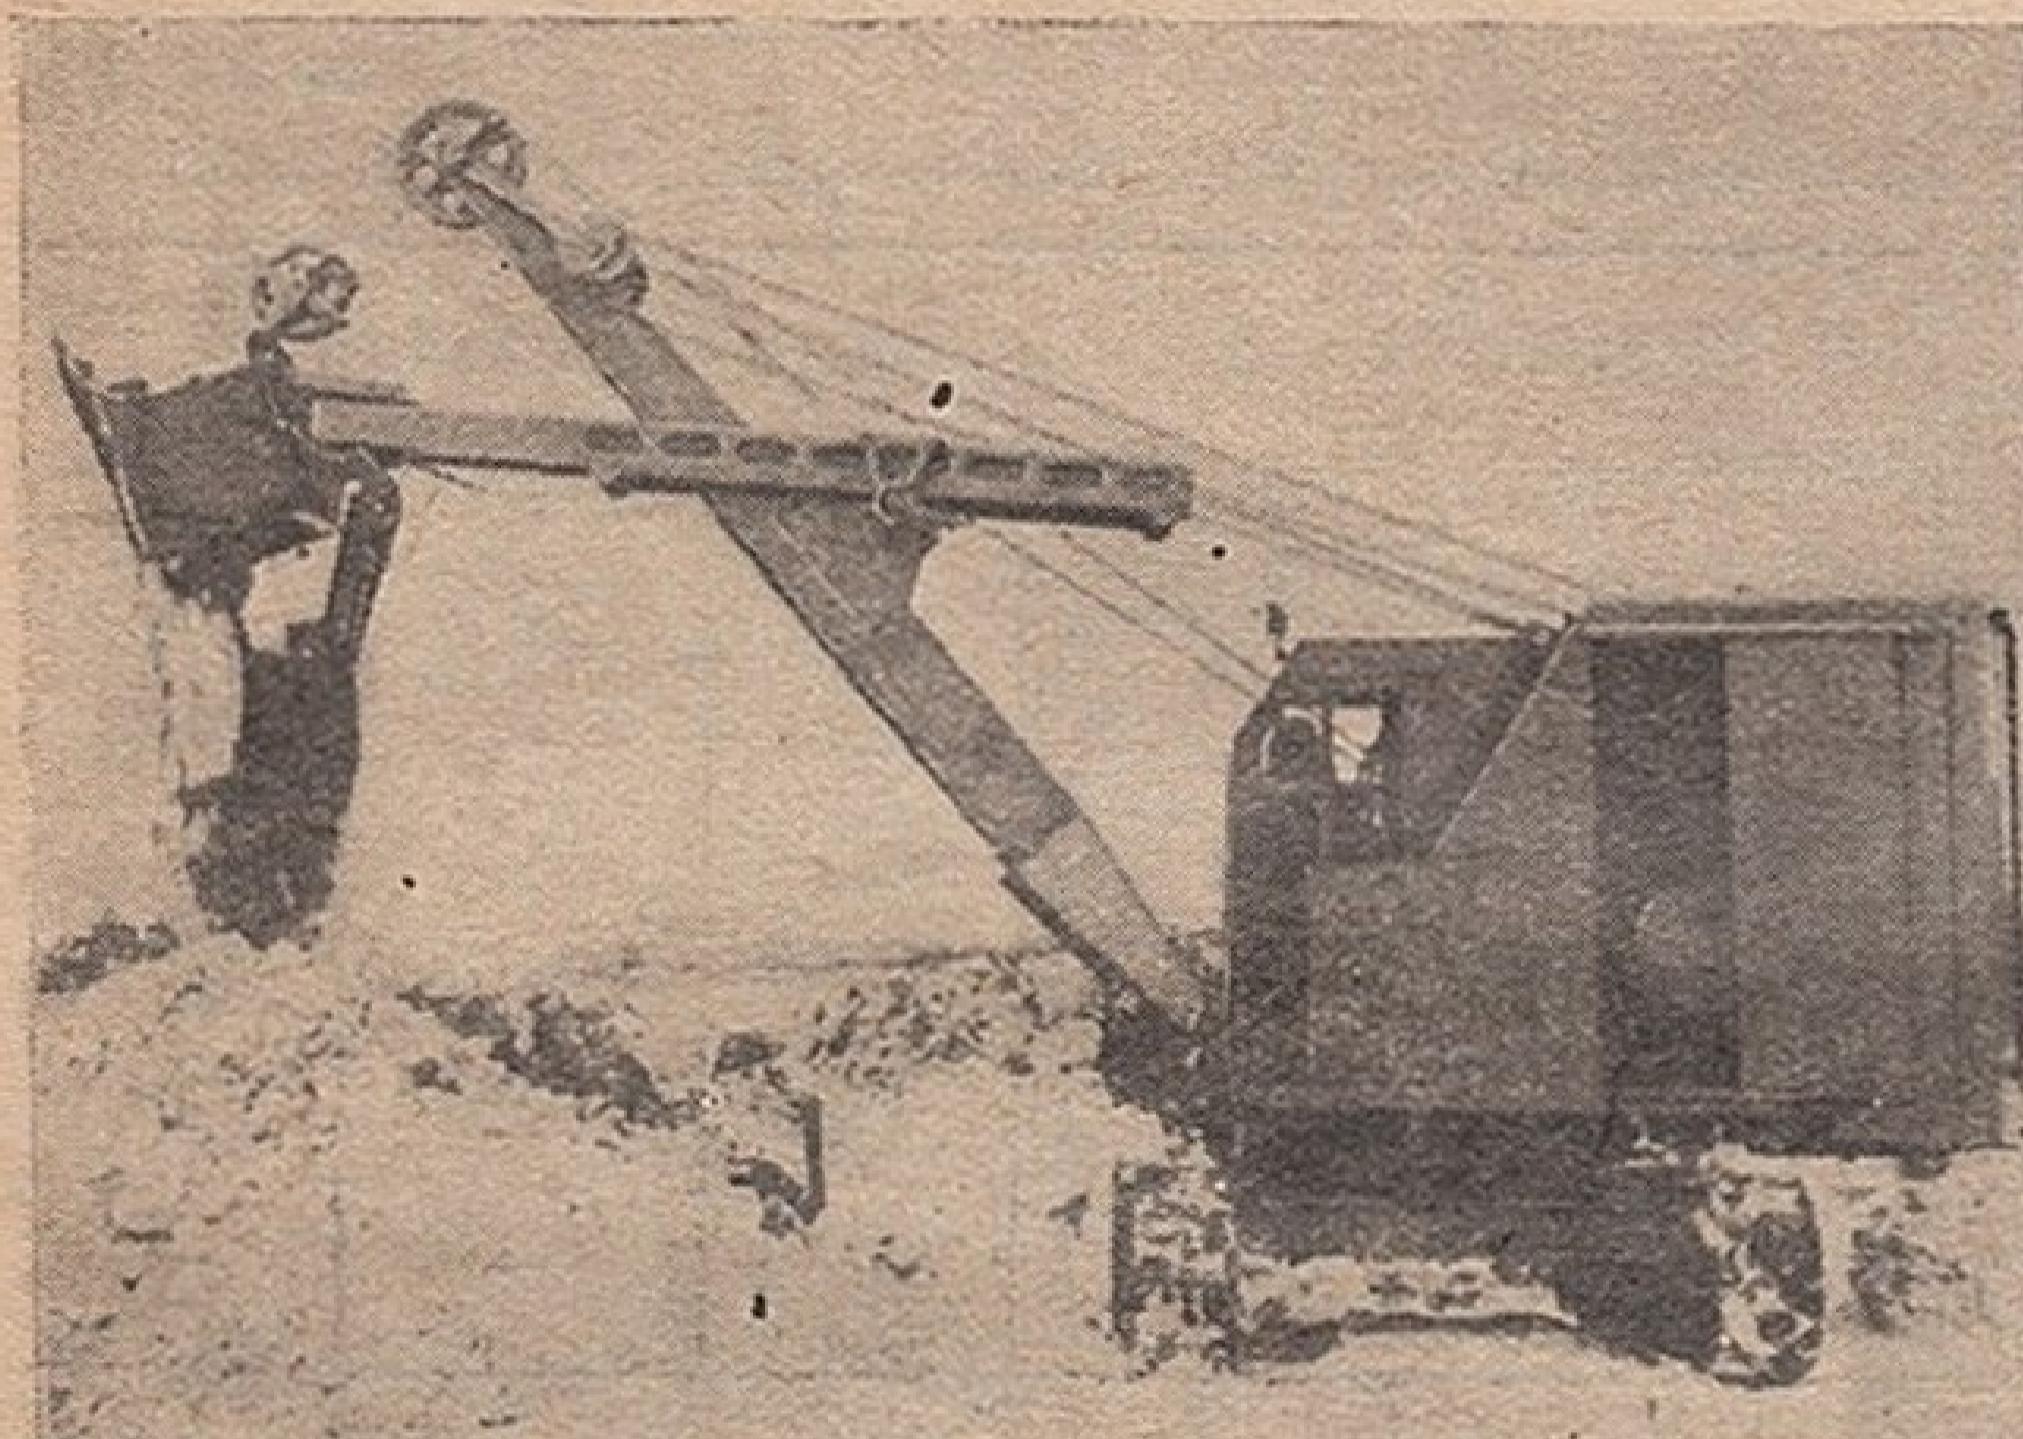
Общий вид экскаватора марки ПГ-0,35
